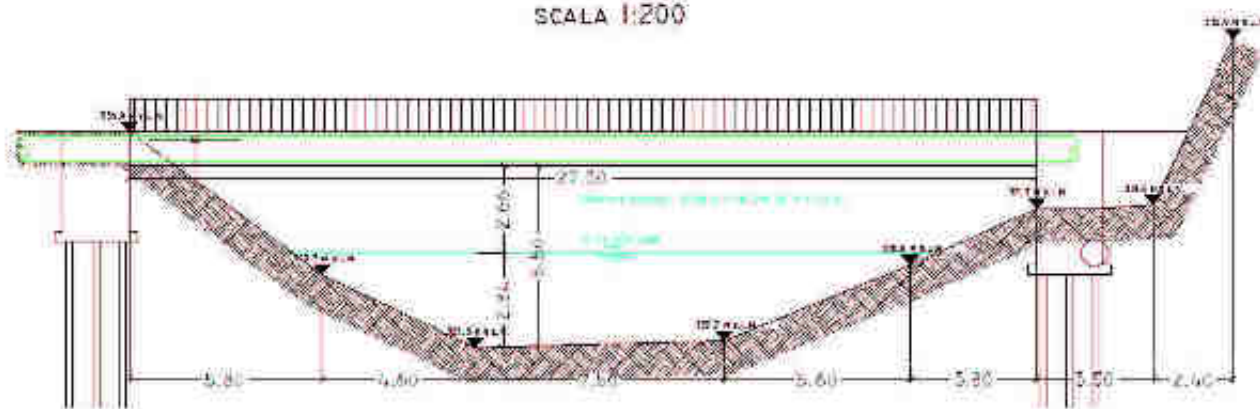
tracciato alternativo - planimetria percorso alternativo con passerella pedonale sul torrente Pescone
